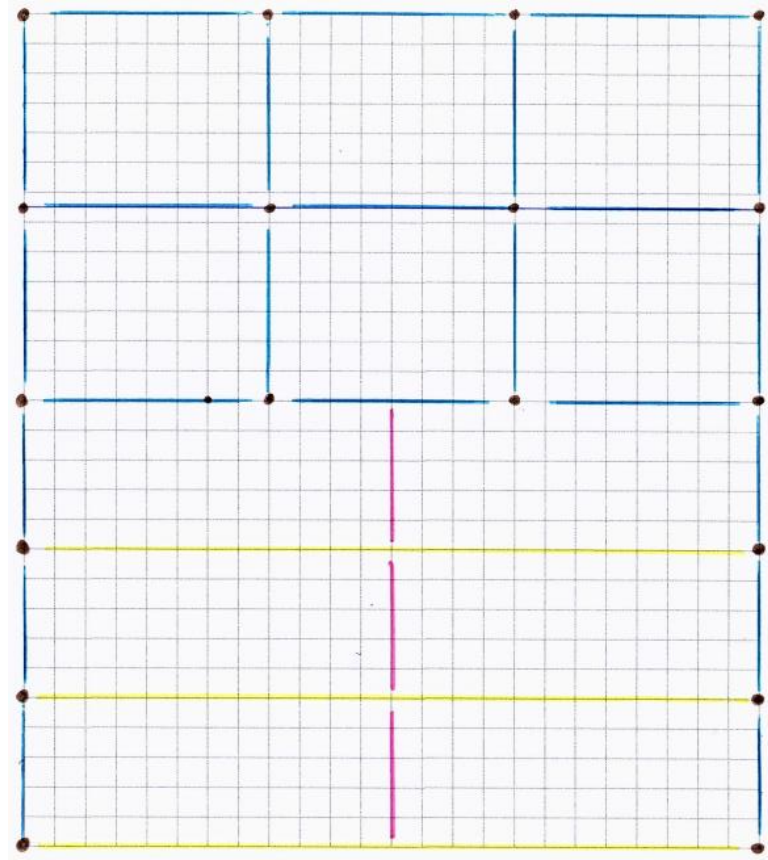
Propuesta de diseño del forjado para la primera planta.
